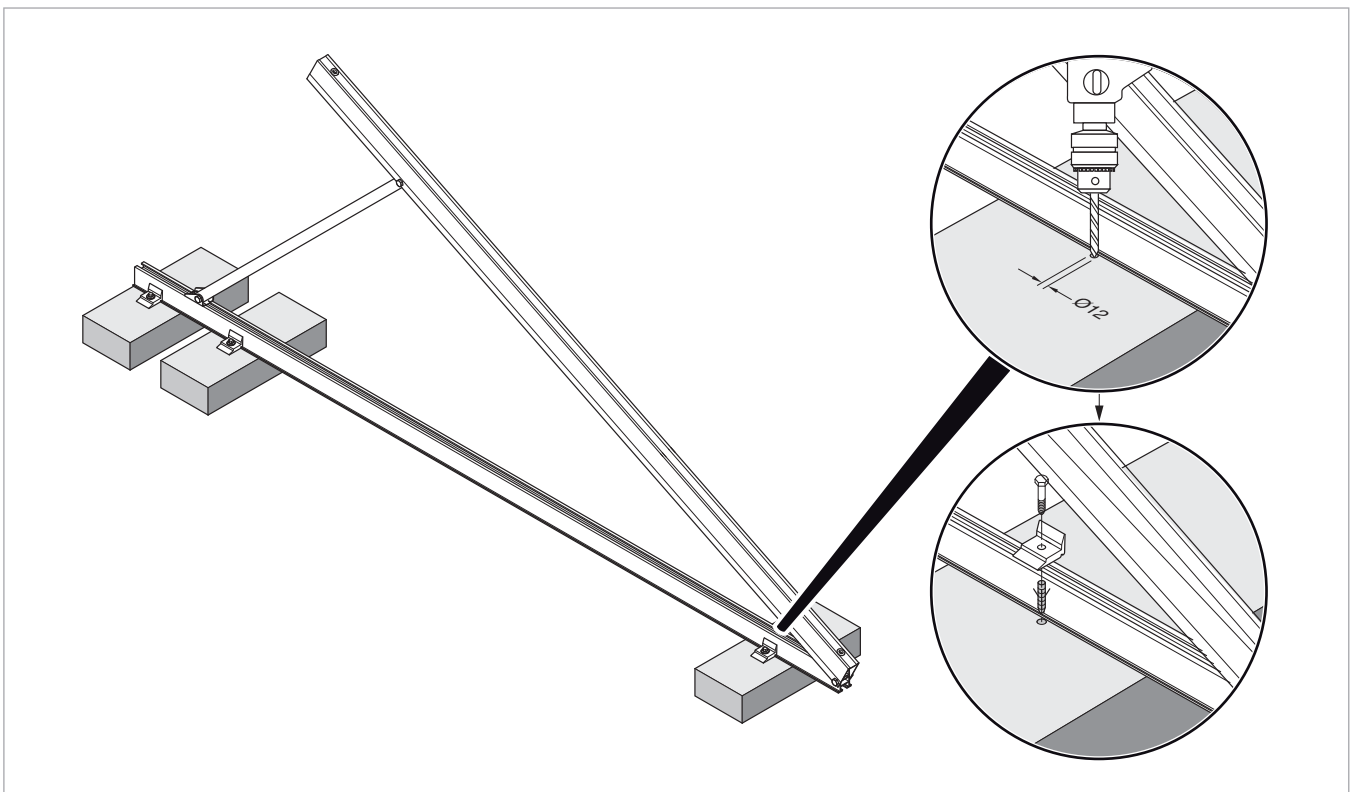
montage du montant pour toit plat sur bloc de béton
